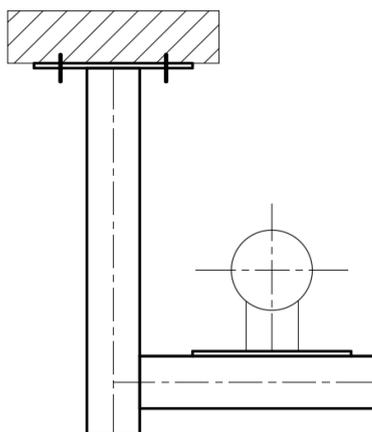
Подпорная конструкция – Г-образная конструкция.
